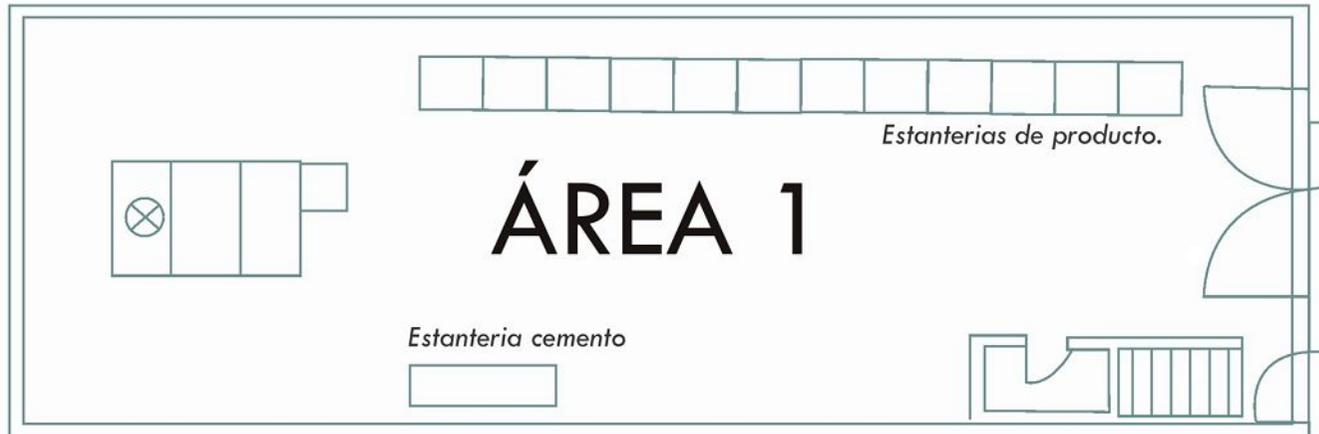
PLANO DE PLANTA # 1 DE YEQUIM S.A.S Donde se encuentra el mayor índice de riesgo.
